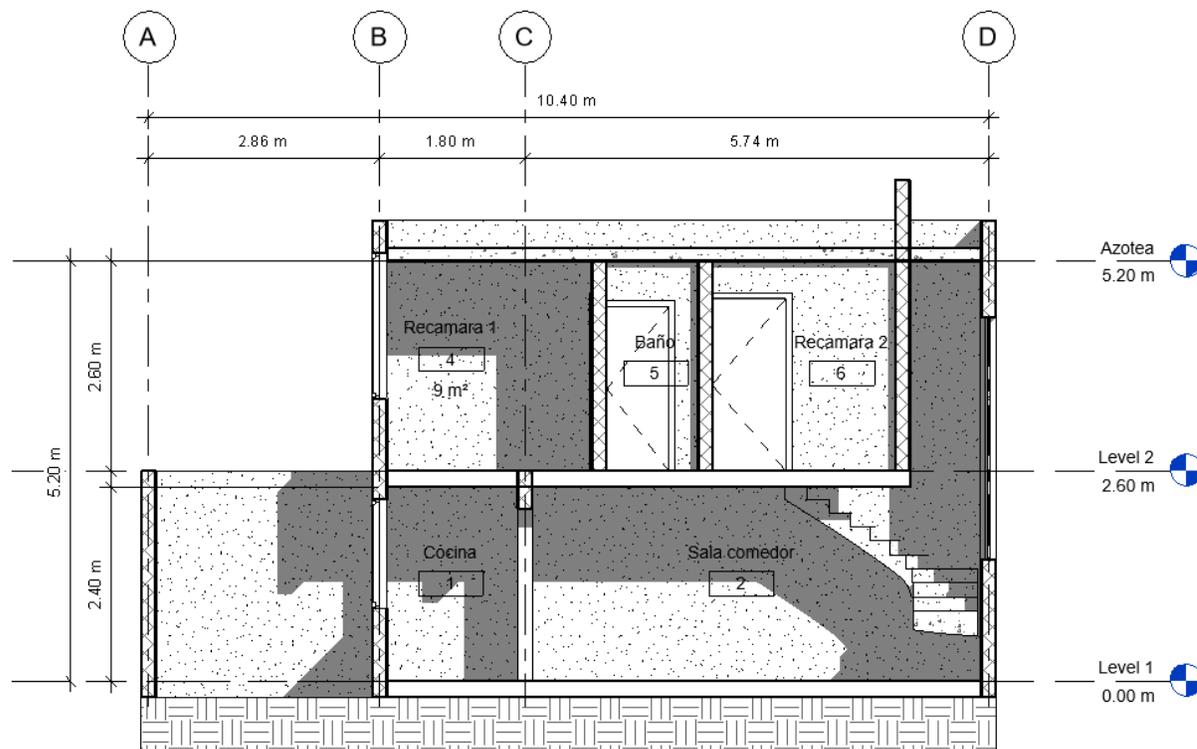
Corte de norte a sur, proyecto arquitectónico
